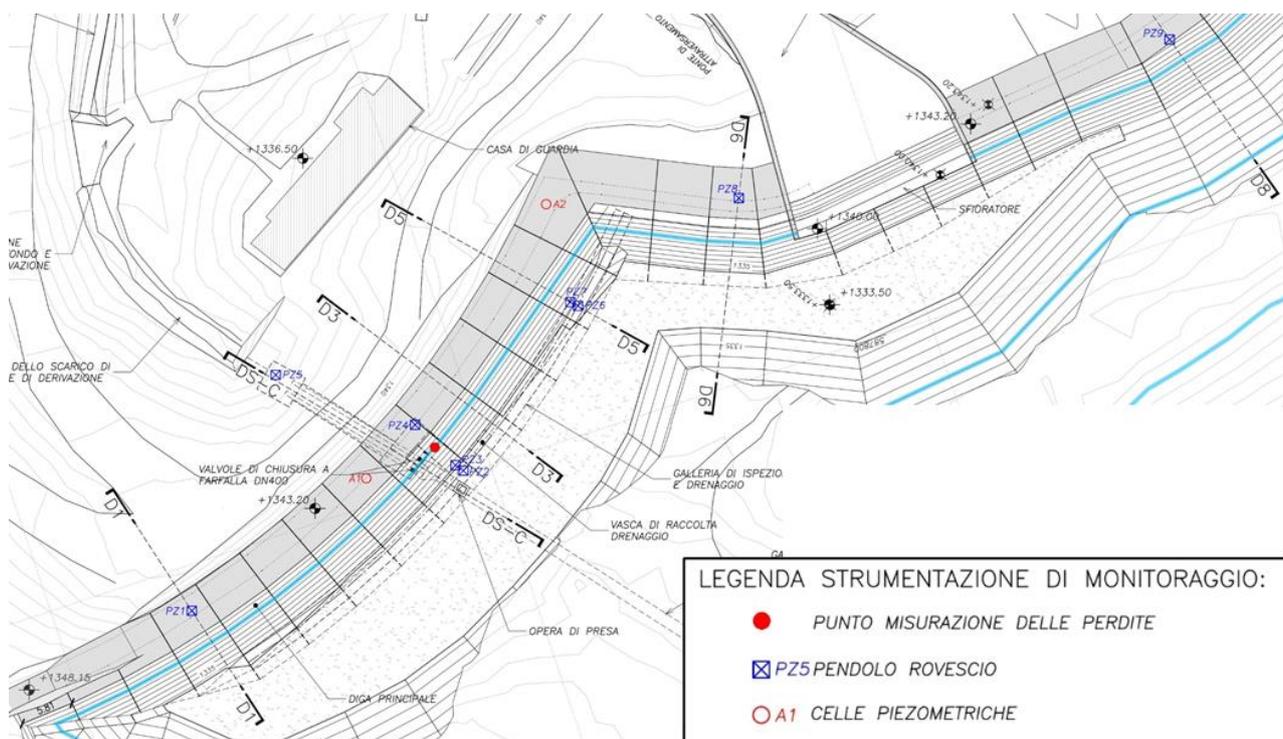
Planimetria della diga con la posizione degli strumenti di monitoraggio
